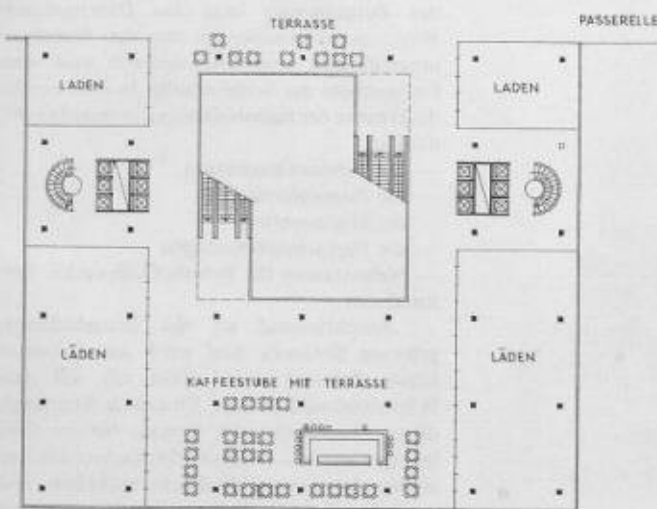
Aufnahmegebäude, Galeriegeschoss, Massstab 1:800
